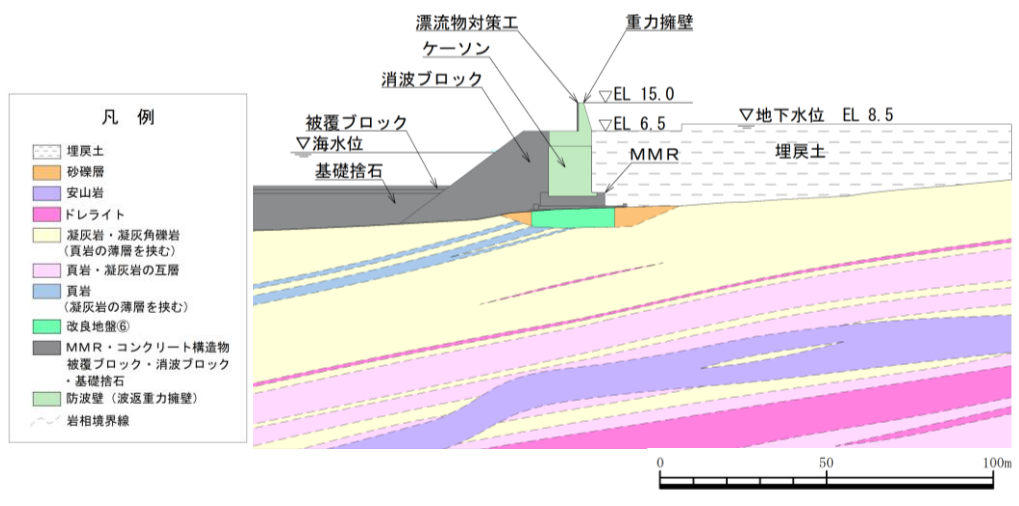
改良地盤⑥の配置図（②-②断面）
